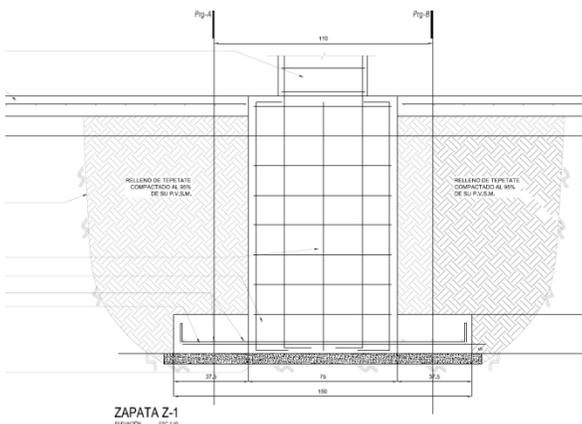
Corte transversal del armado de zapata principal del Pabellón de Arte Urbano. (Archivo Personal)
